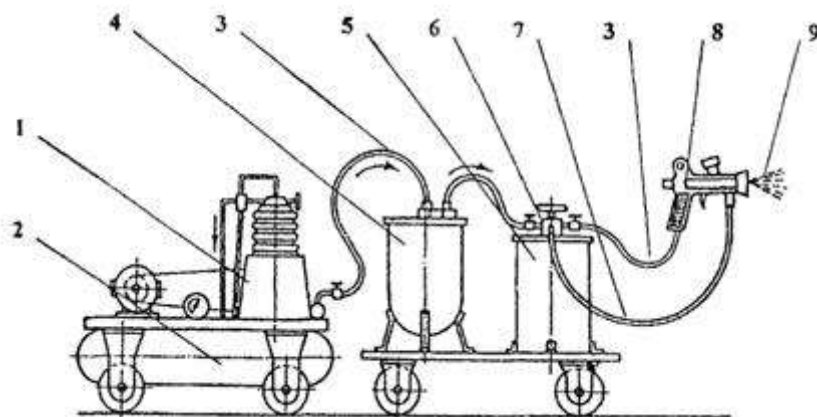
Схема компрессорного огрунтовочного агрегата
